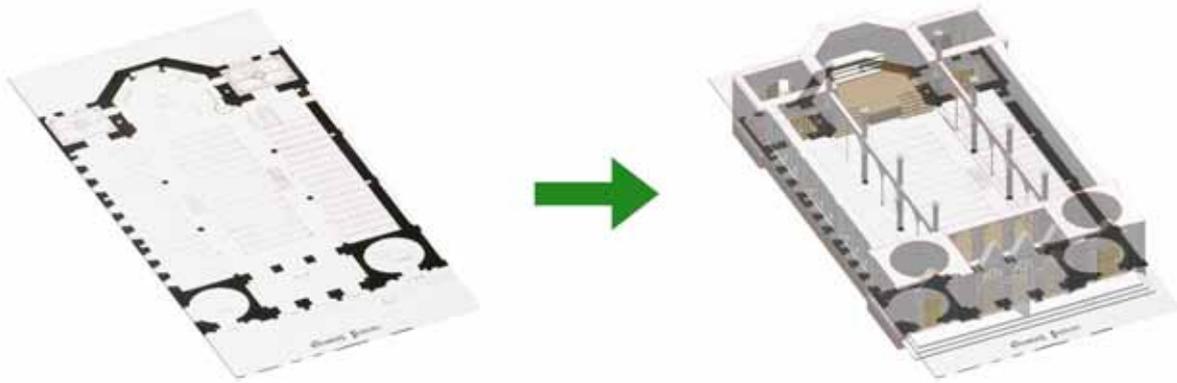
Modellierungsarbeit auf dem Grundriss
